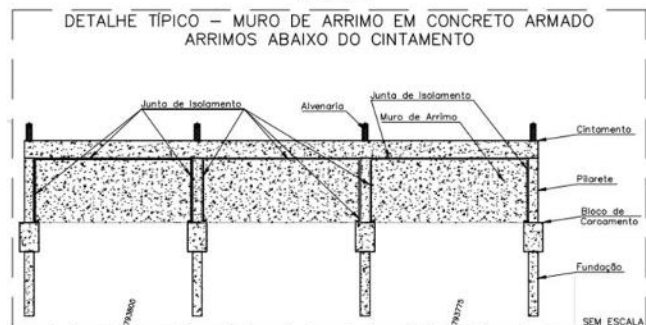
Detalhe típico dos muros de arrimo em concreto armado que serão executados.
